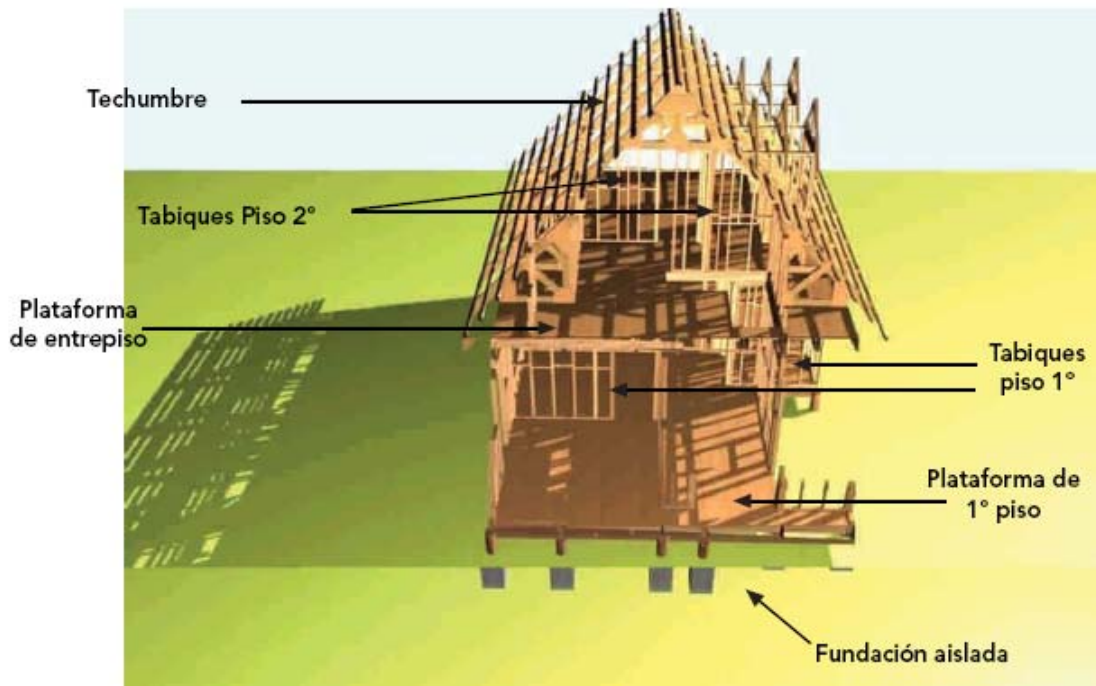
1: Corte de la vivienda especificando sus componentes estructurales principales.
